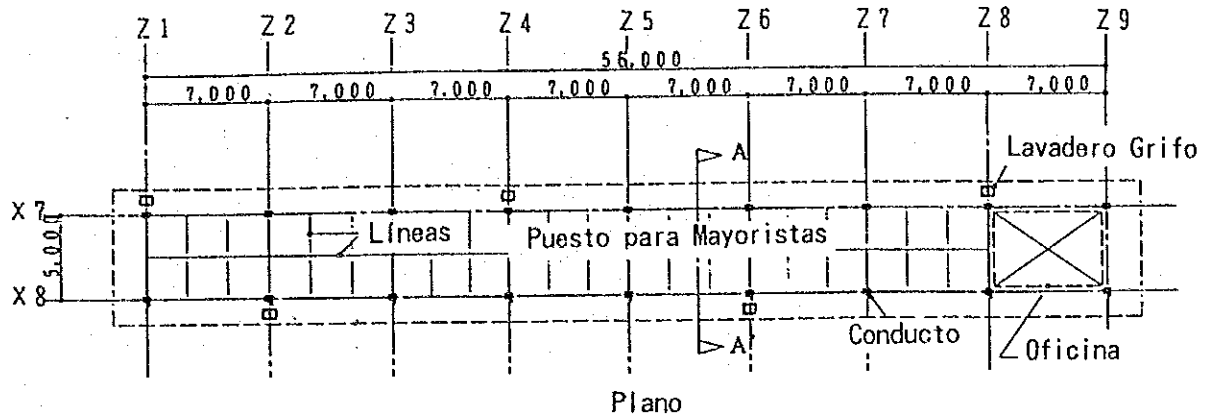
PLANO HORIZONTAL DEL MERCADO MAYORISTA
